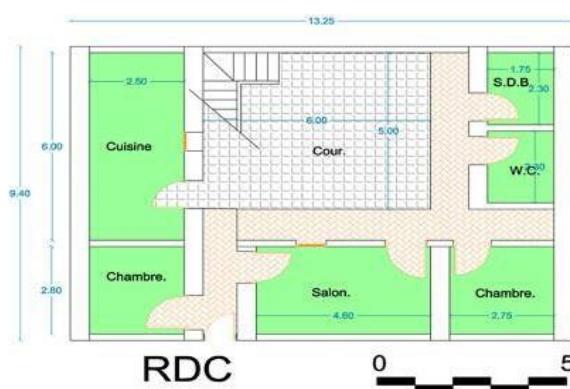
Plan RDC d'une maison de ksar Laghouat
